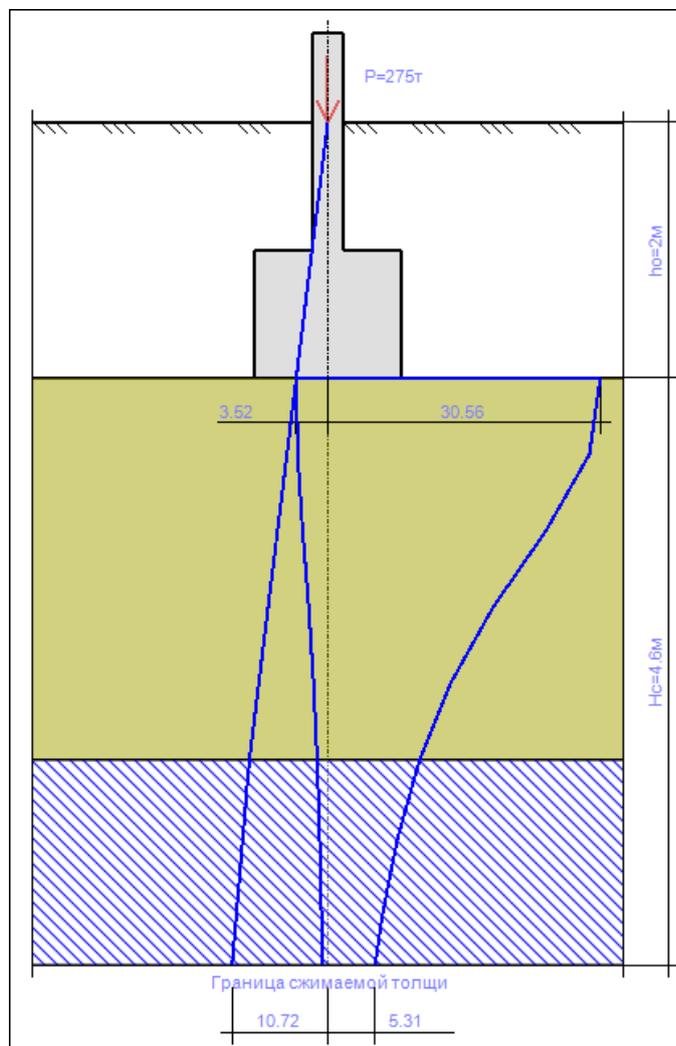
Расчетная схема к определению осадки Фк – 3 и эпюры напряжений
